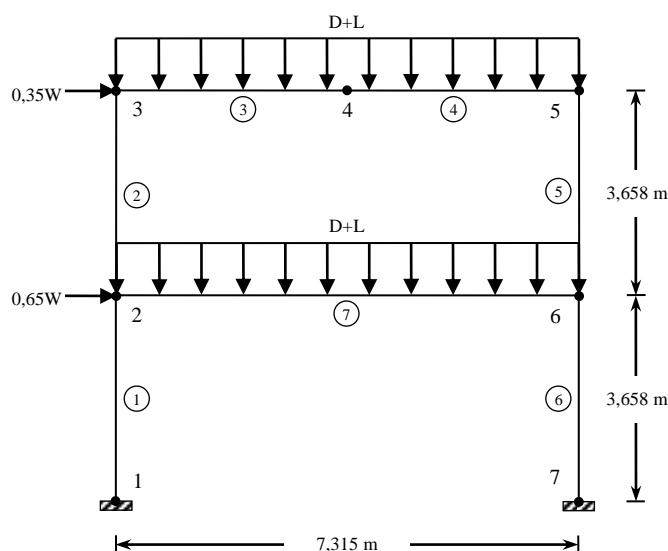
Pórtico plano com sete elementos: geometria, carregamento e discretização
